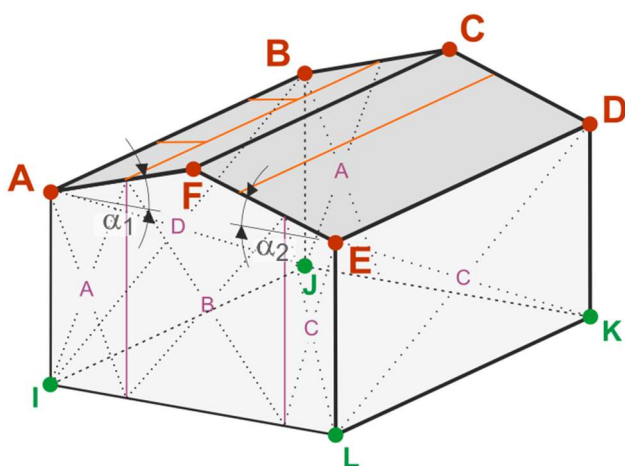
Muros verticales con cubierta a dos aguas y zonas de carga de viento.
